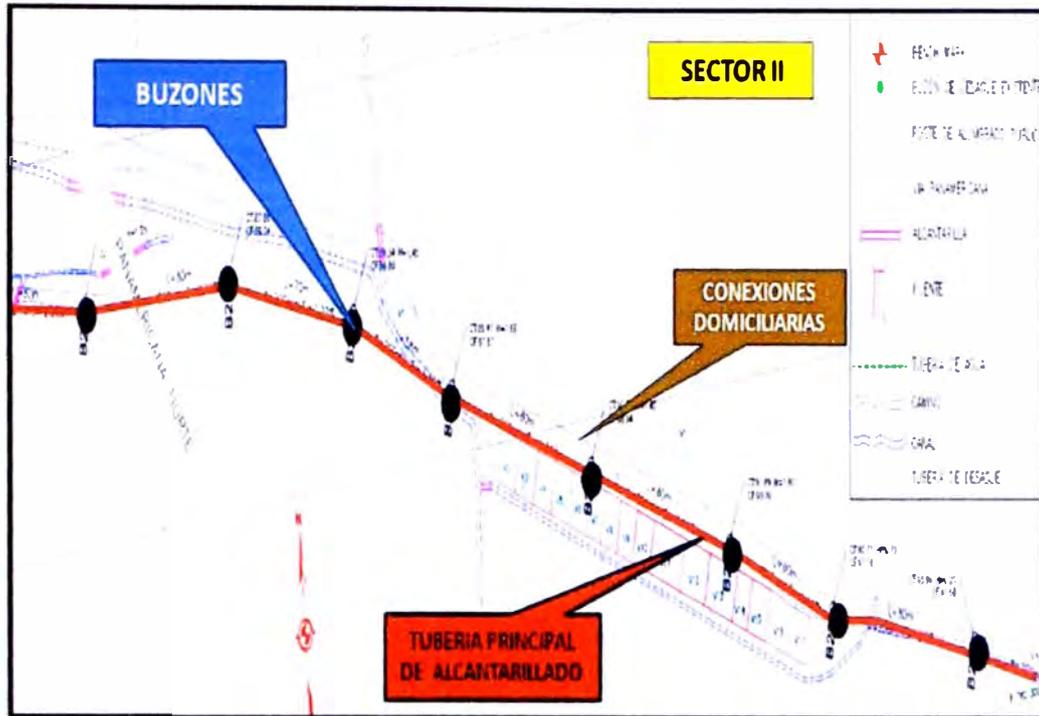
Sector II: Sistema de Alcantarillado-I I.
